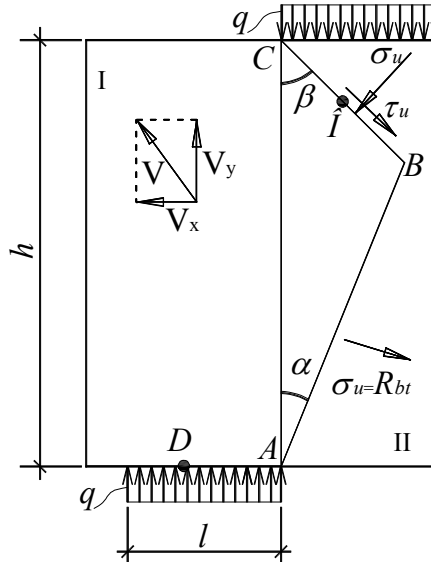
Кінематично можлива схема руйнування зразка Е. Мерша
